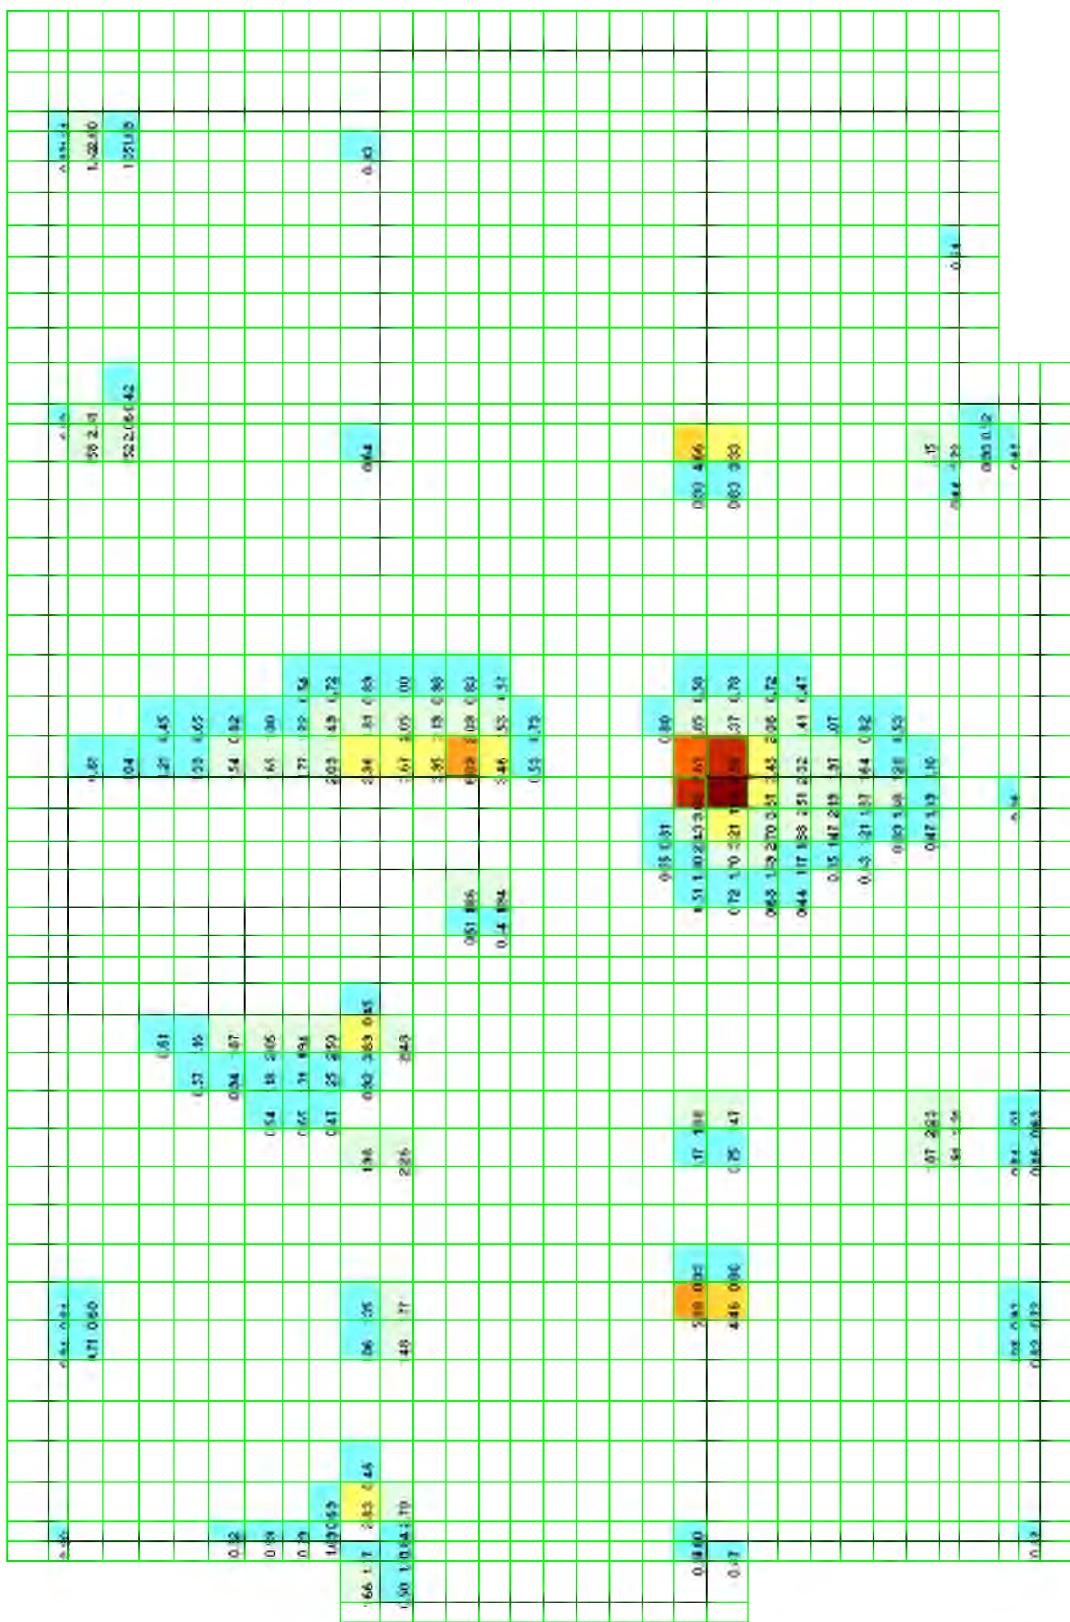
Площа арматури ЧП по осі У (Армування верхньої зсн)
